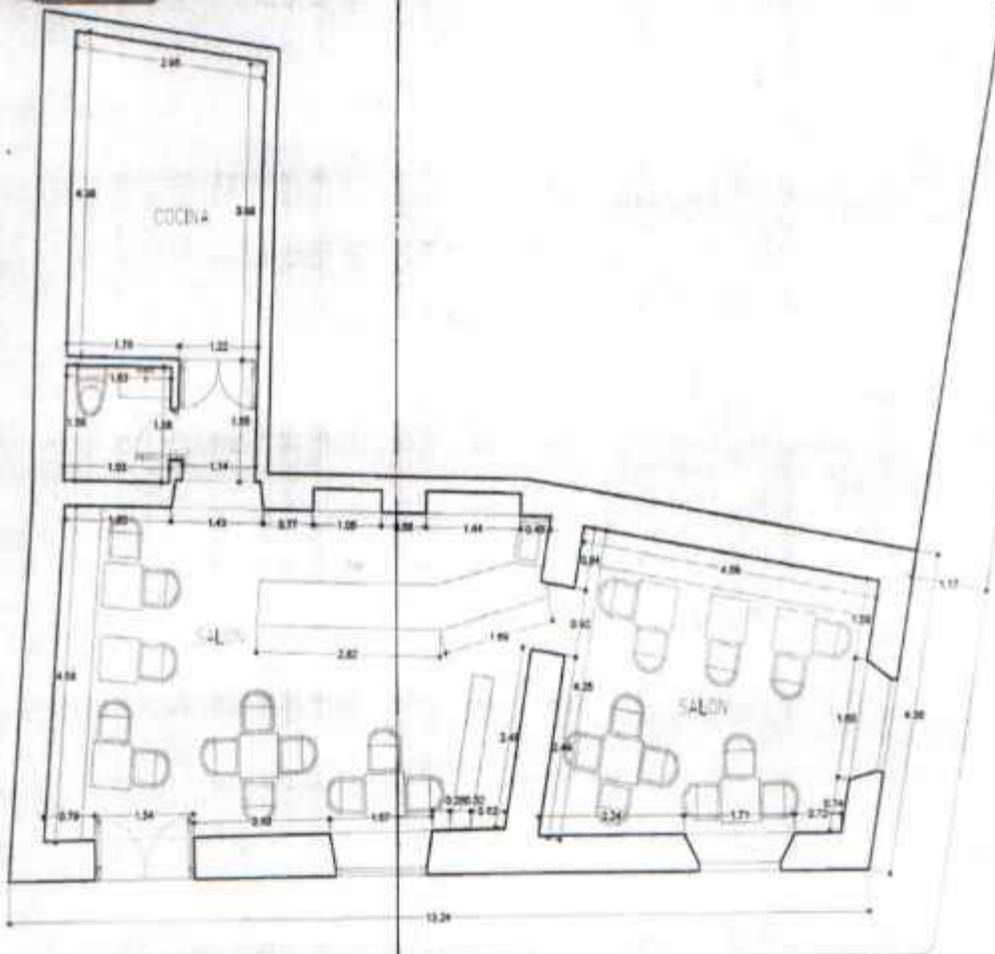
Plano RESTAURANTE BONCHE GASTRO BAR - Área privada.
